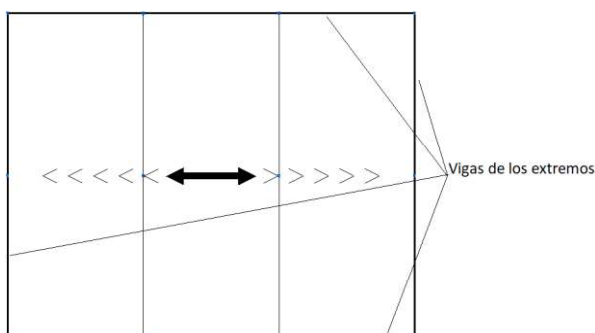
Vista de la planta del altillo de la nave secundaria.
